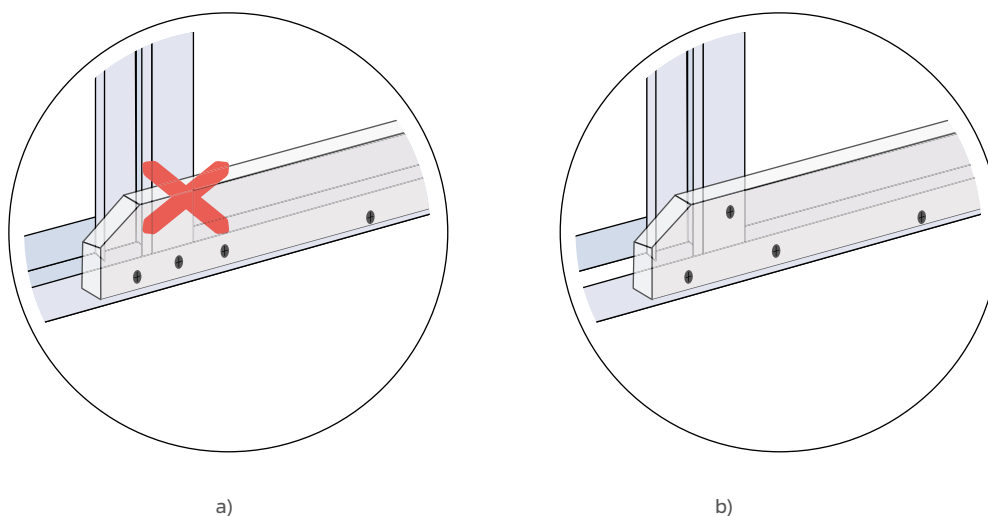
a) Fixação simultânea entre placa, perfil montante e perfil raia;
